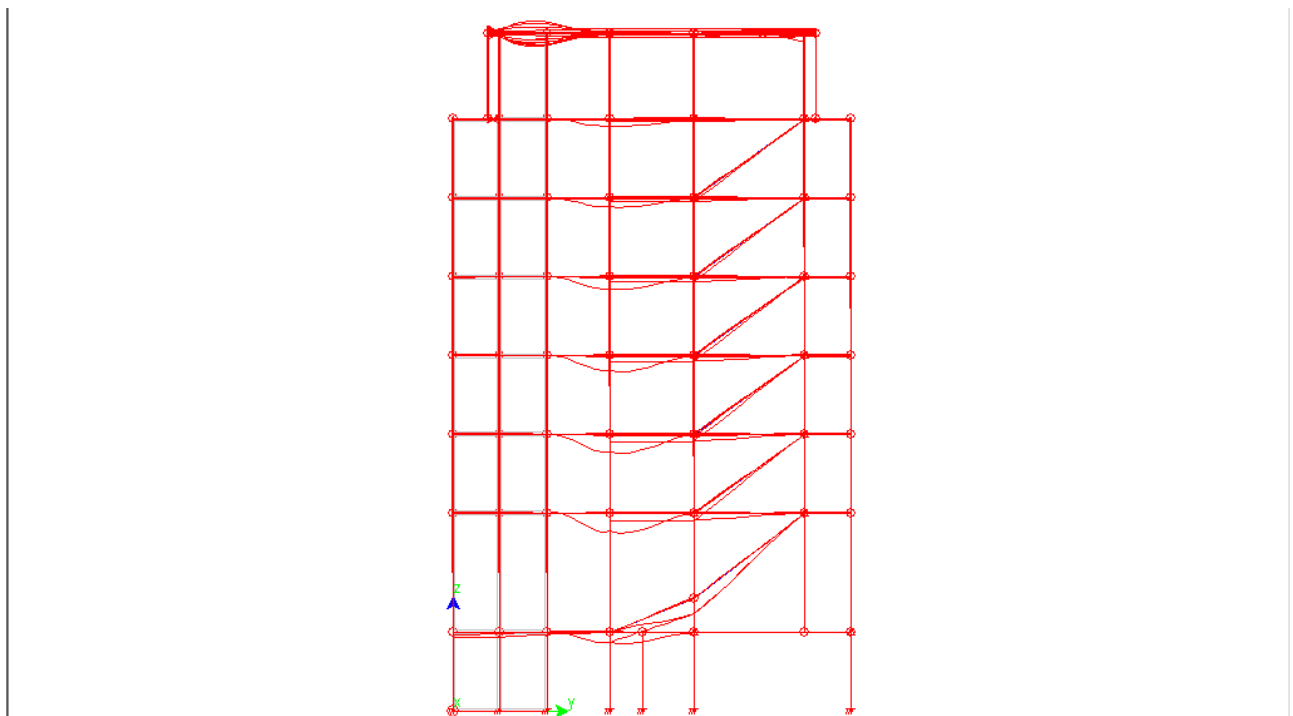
DEFORMATA DEL PRIMO MODO DI VIBRARE – PROSPETTO TRASVERSALE
